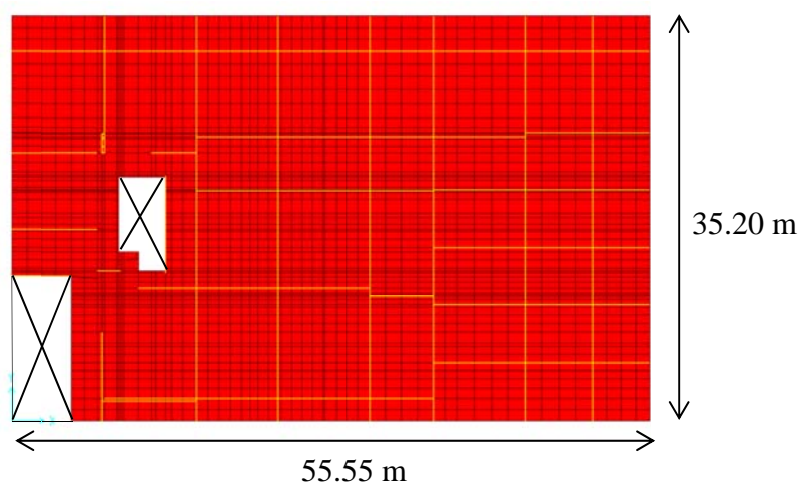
Dimensiones de la Planta Cielo Subterráneo (S/E).
